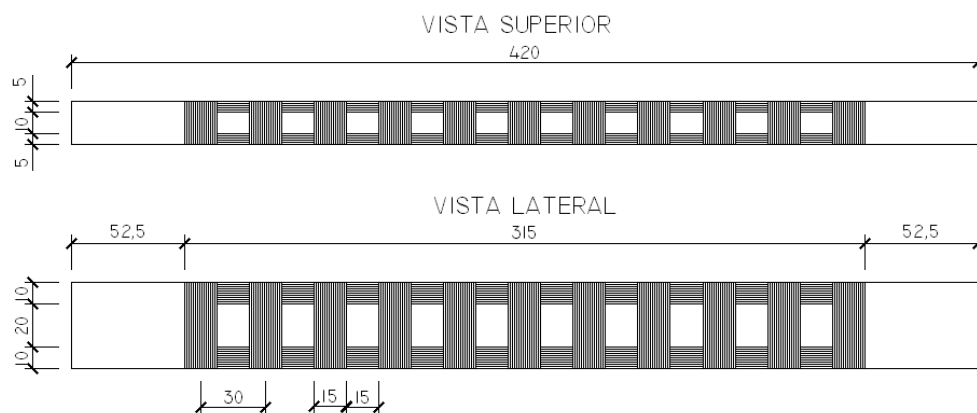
Viga de concreto armado com reforço transversal e longitudinal.
